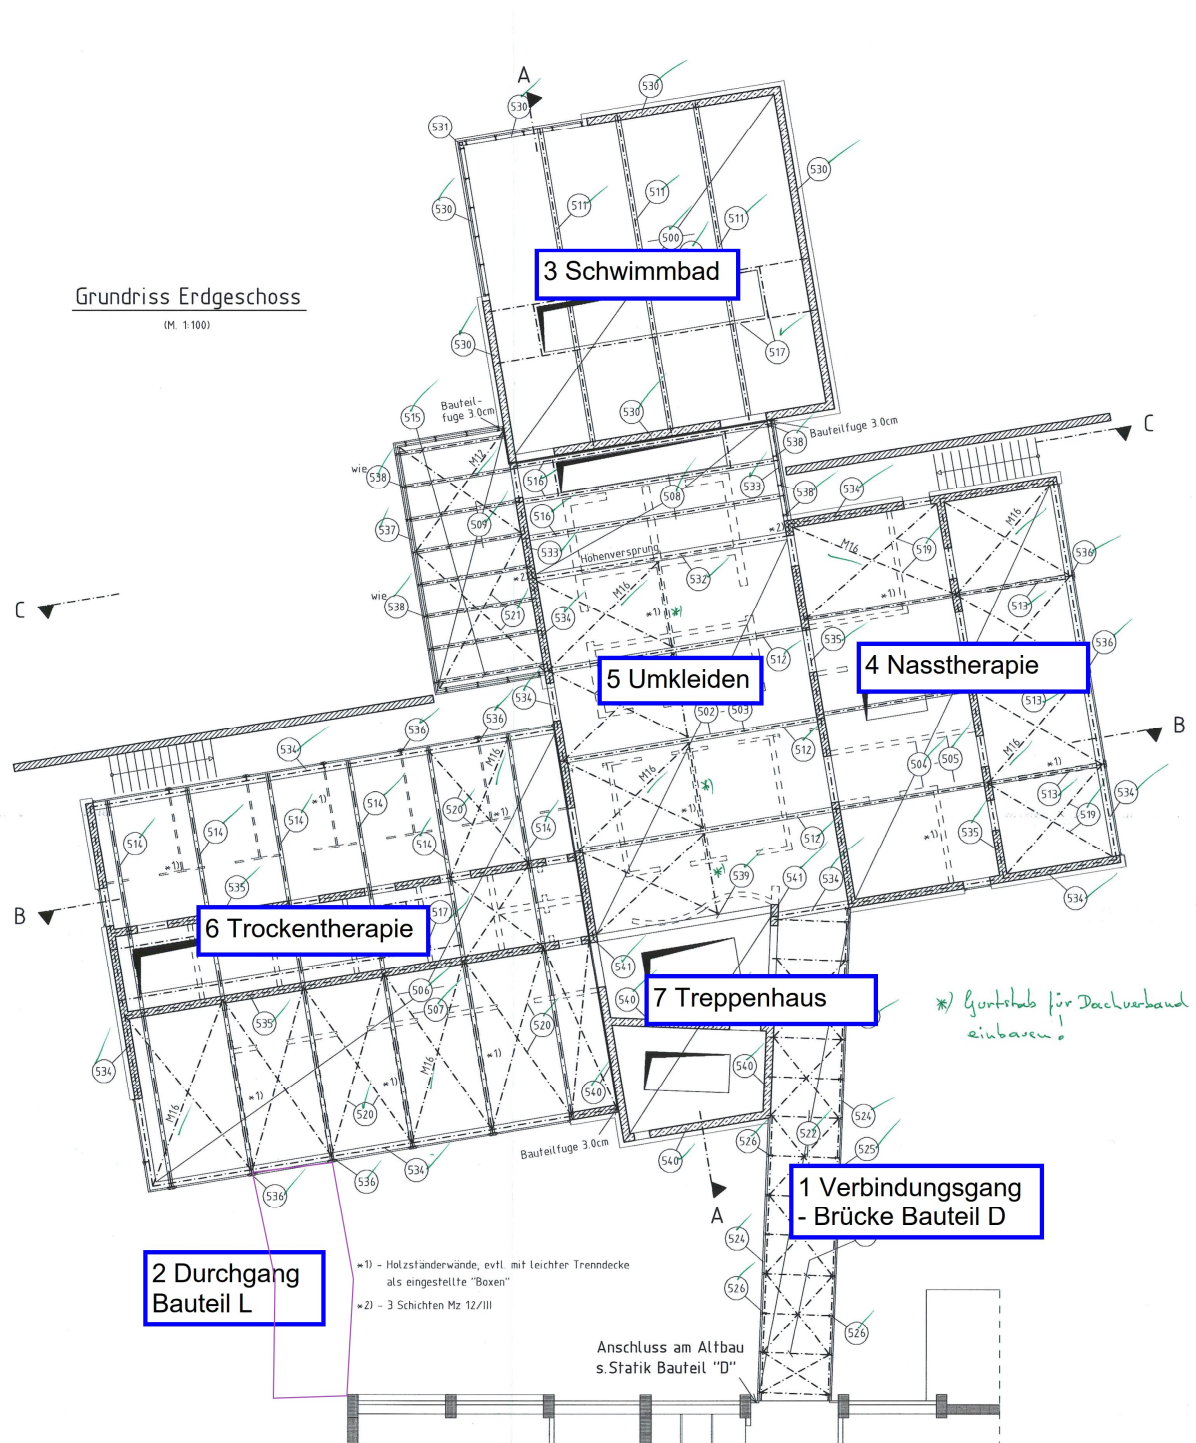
Auszug aus dem Positionsplan P6 Bauteil E Erdgeschoss vom 15.10.03
